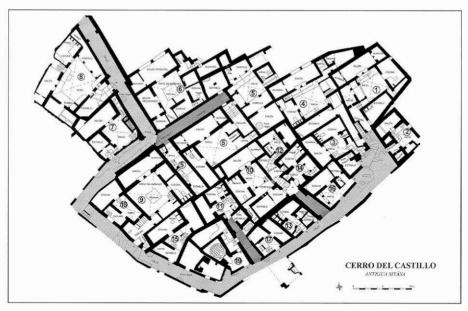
Croquis con la planta del barrio de casas excavado en el despoblado islámico de Siyâsa (Cieza, Murcia). En gris claro hemos señalado las calles públicas y en gris oscuro los adarves.
